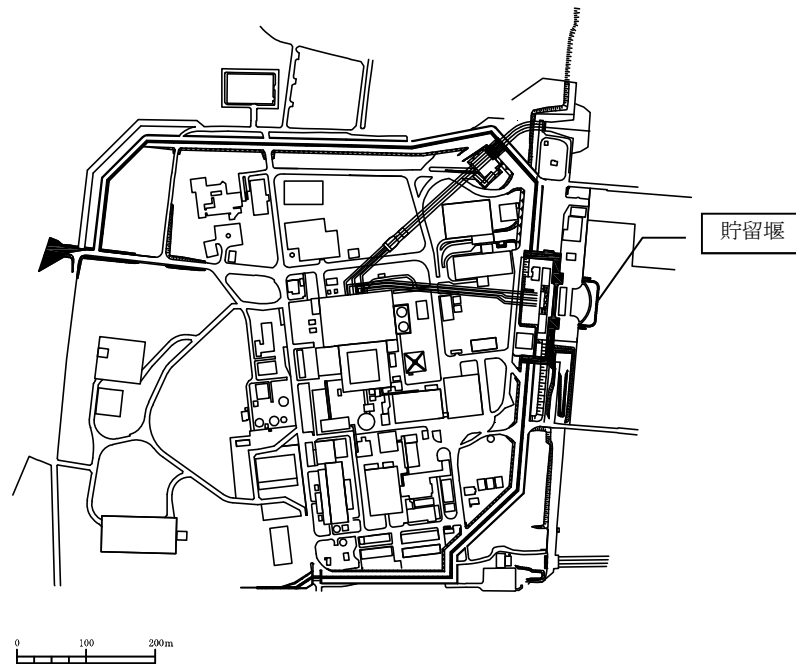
(1) 貯留堰の平面配置図（全体図）
